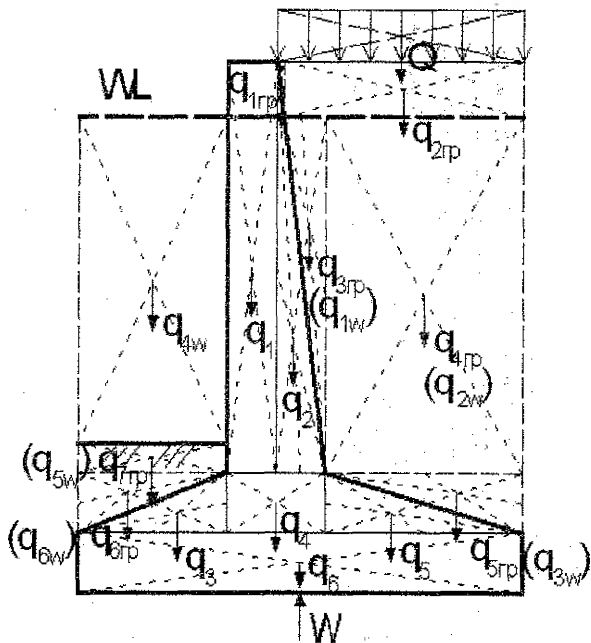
Схема вертикальных нагрузок, действующих на подпорную стенку в период ее эксплуатации
